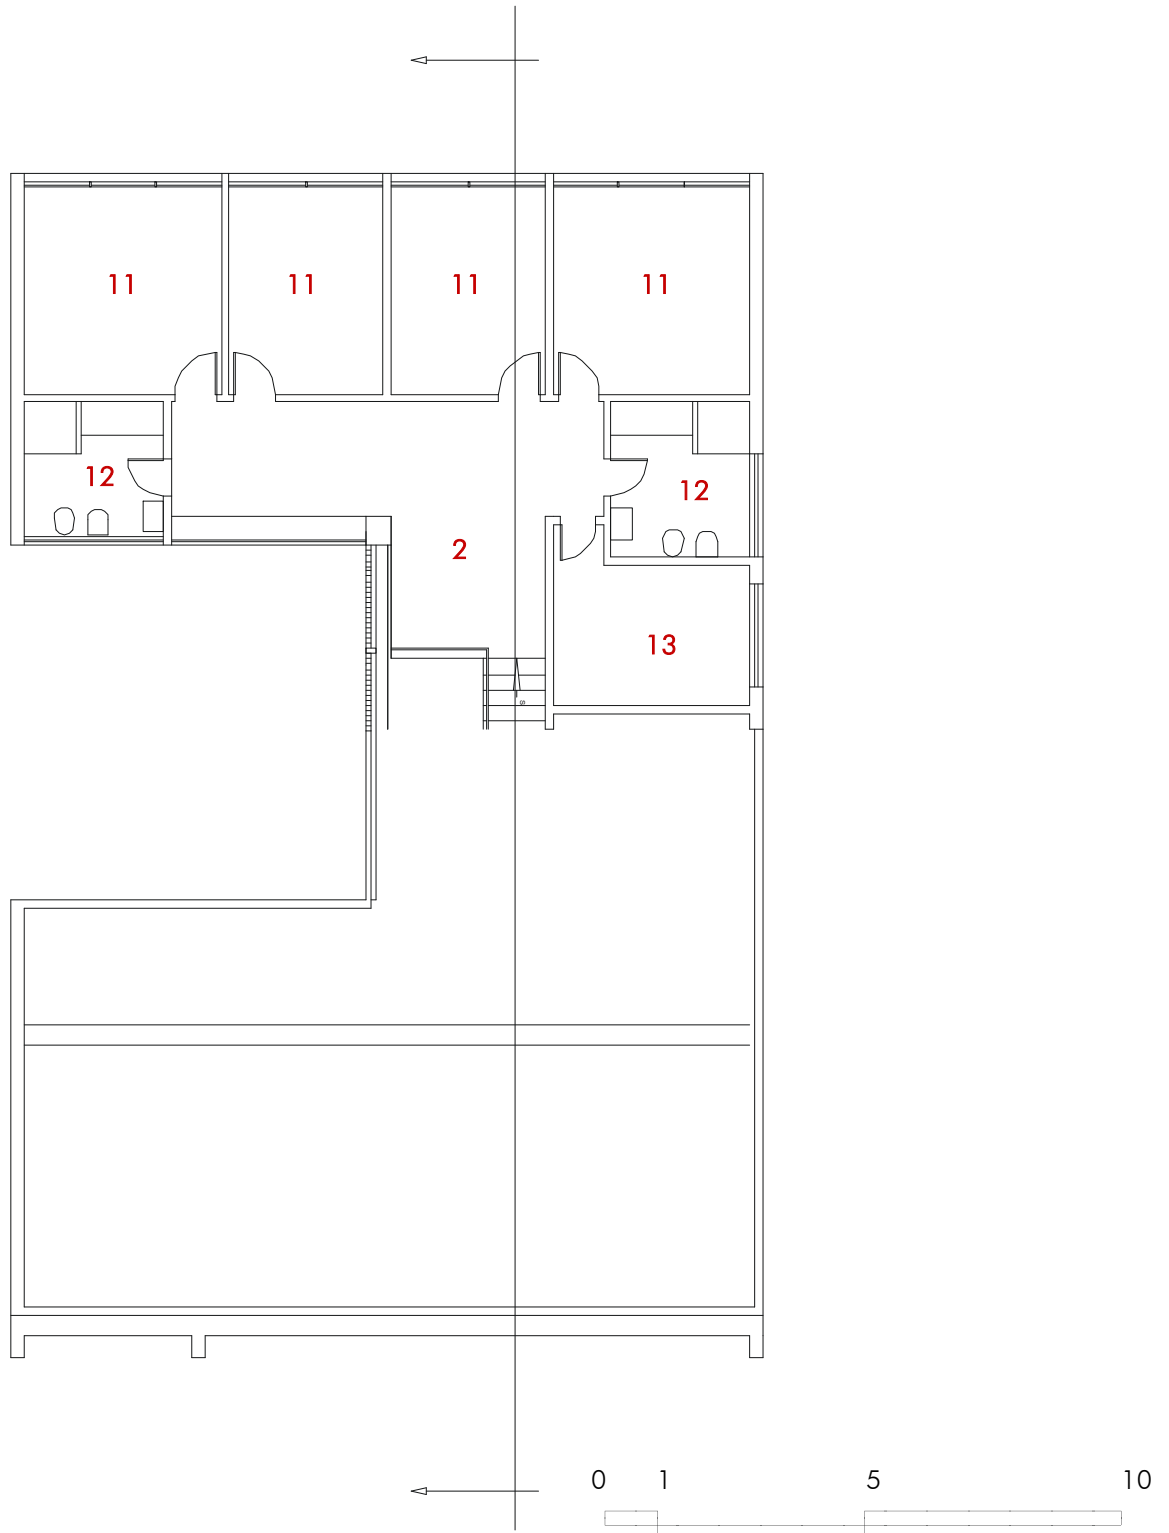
Planta pavimento superior: Residência Luiz Bevilacqua.
